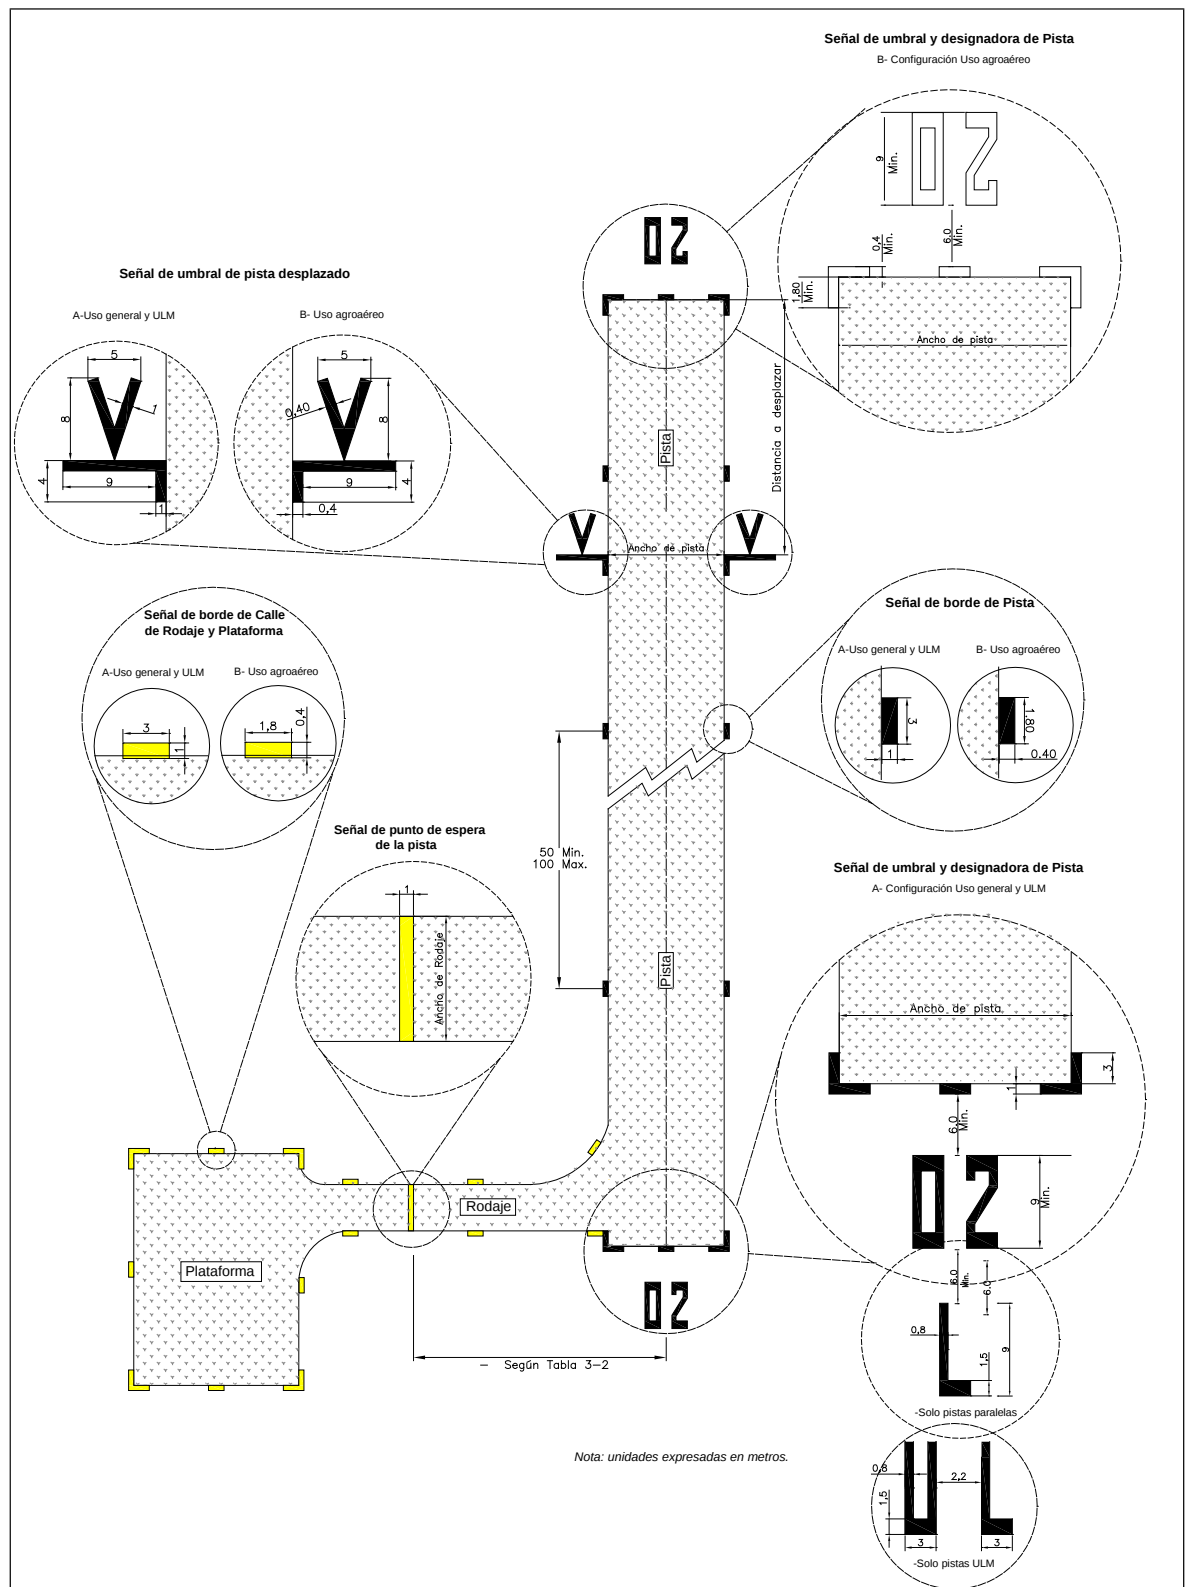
Señalamiento diurno para pistas no pavimentadas
